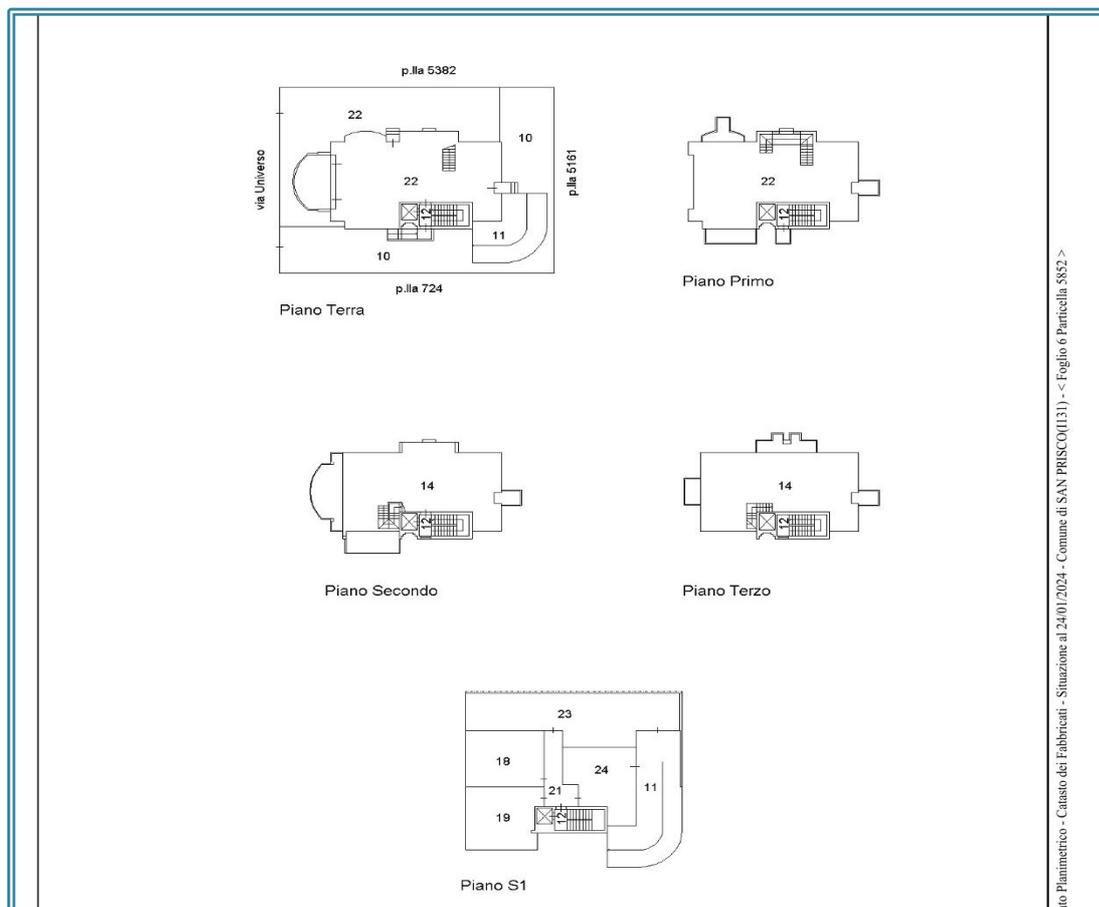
Elaborato planimetrico (LOTTE 1,2,3,4,5,6)
